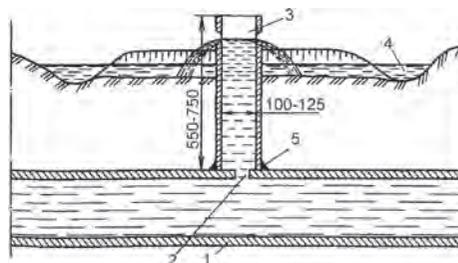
Закрытый автоматизированный поливной трубопровод (АПТ) для полива садов и виноградников:
